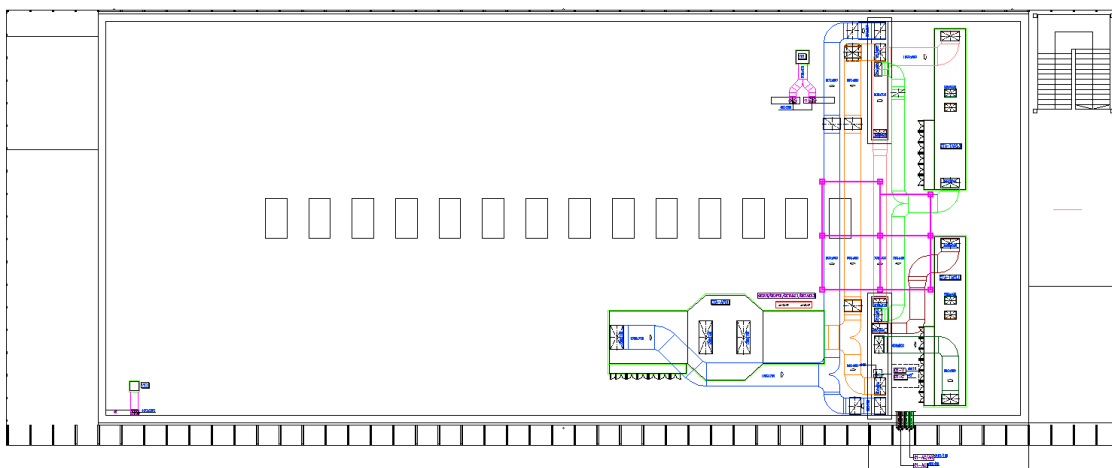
Pianta piano terra scuola: impianto termico in progetto
